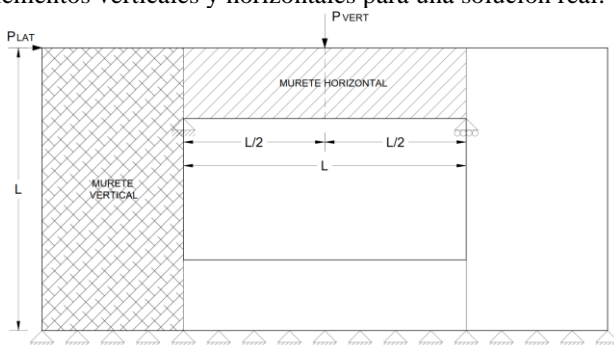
Muro de adobe con vano, idealizado como murete vertical y murete horizontal
